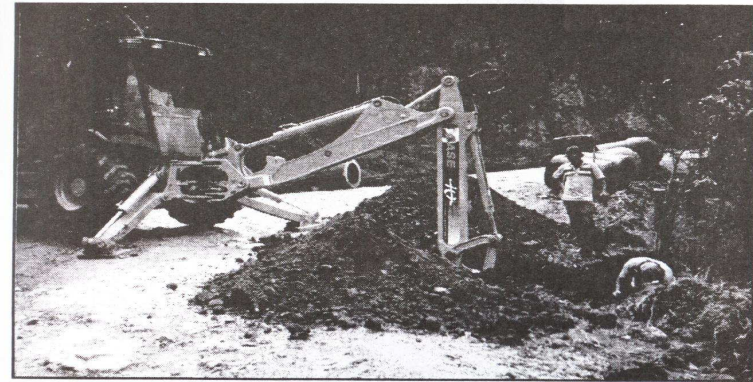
Excavación para una alcantarilla utilizando un retroexcavador
